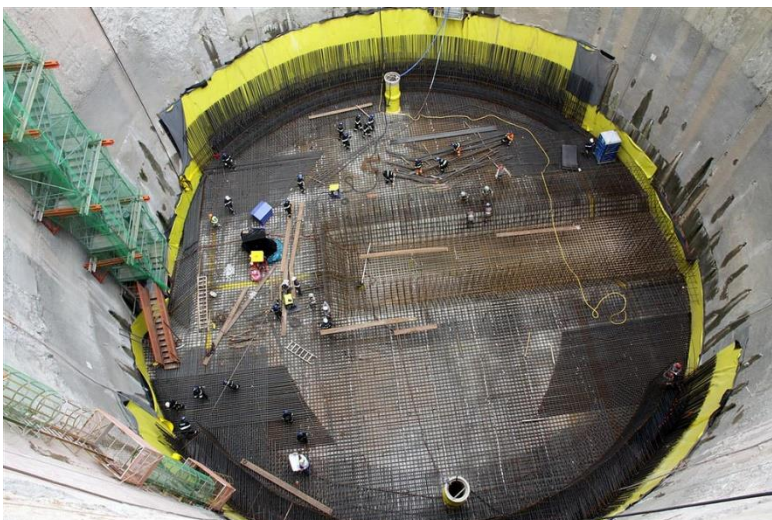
Ponte Akashi-Kaikyo, fundada em 1998.
